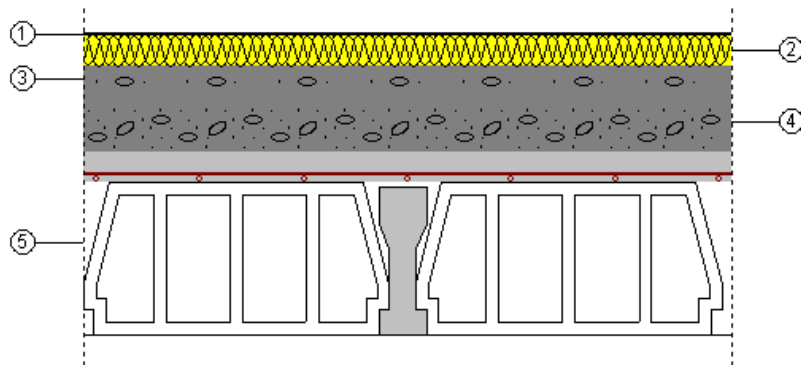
Vista de sección de la cubierta. Fuente: [7]
